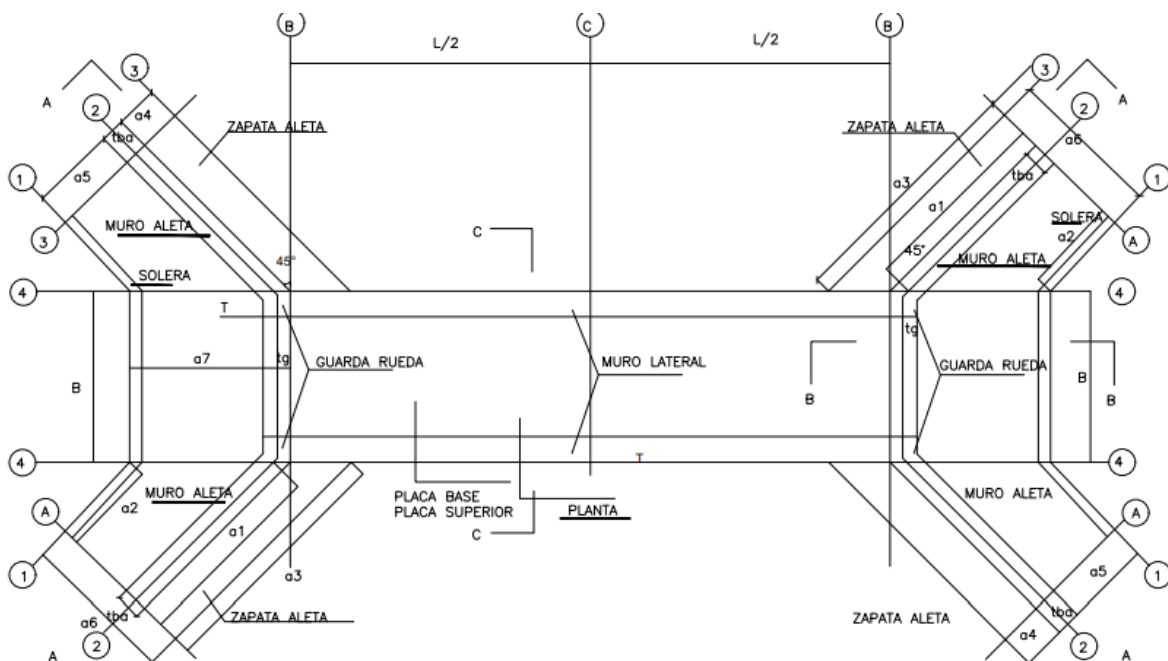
Vista en planta de Box Culvert tipo. Fuente: Manual de obras menores de drenaje y estructuras viales. INVIAS 2020
